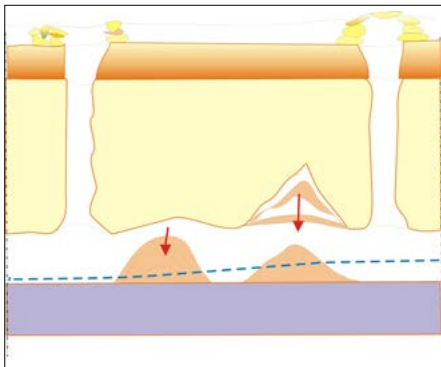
D – Ostruzioni per erosioni e crolli dalle pareti e tetto della galleria
